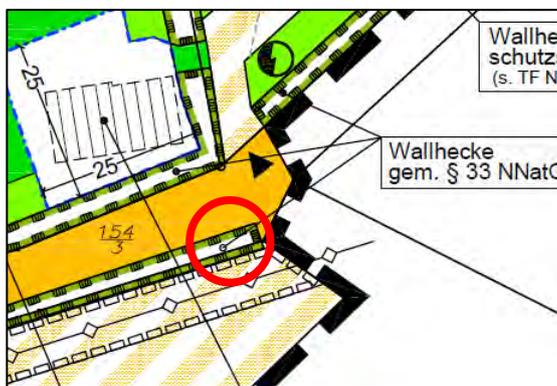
Ausschnitt Wallhecke aus B-Plan Nr. 83 A (unmaßstäblich)
